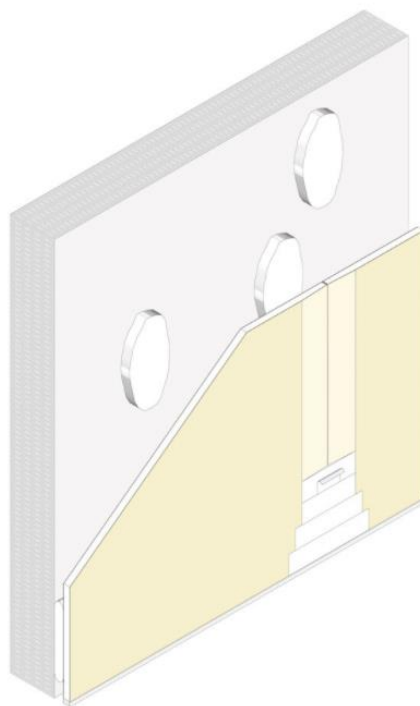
Pladur directe 12,5 mm. Pladur Gypsum, 2021.
